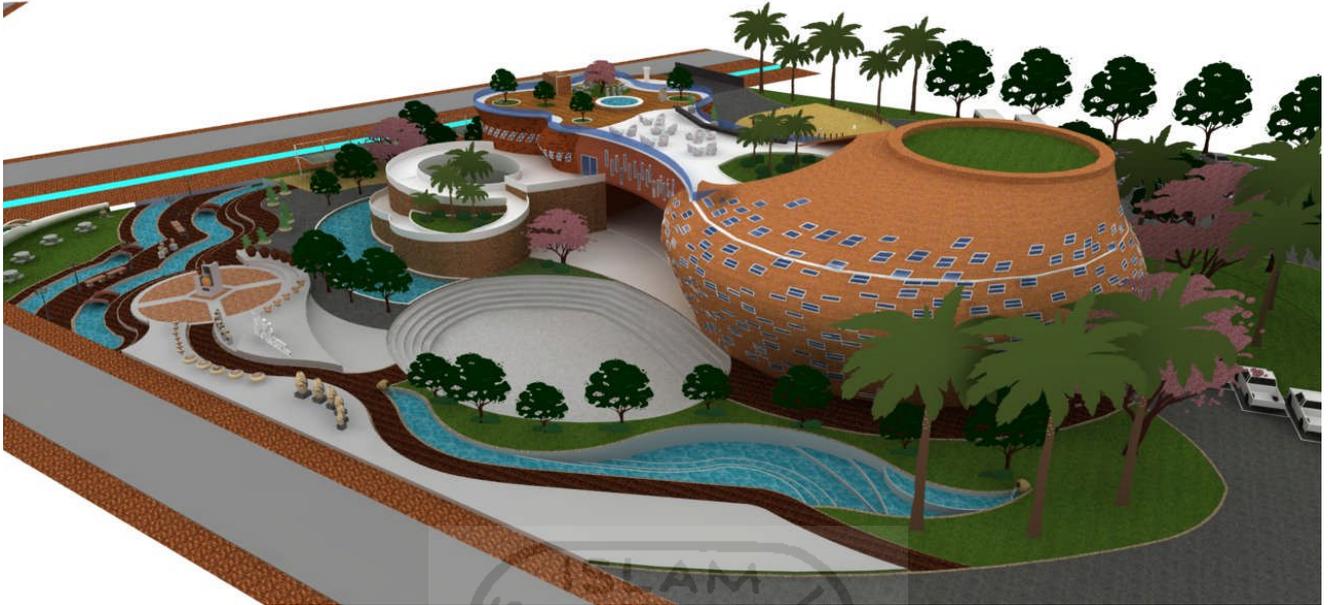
Tampak Bangunan dan galeri outdoor
